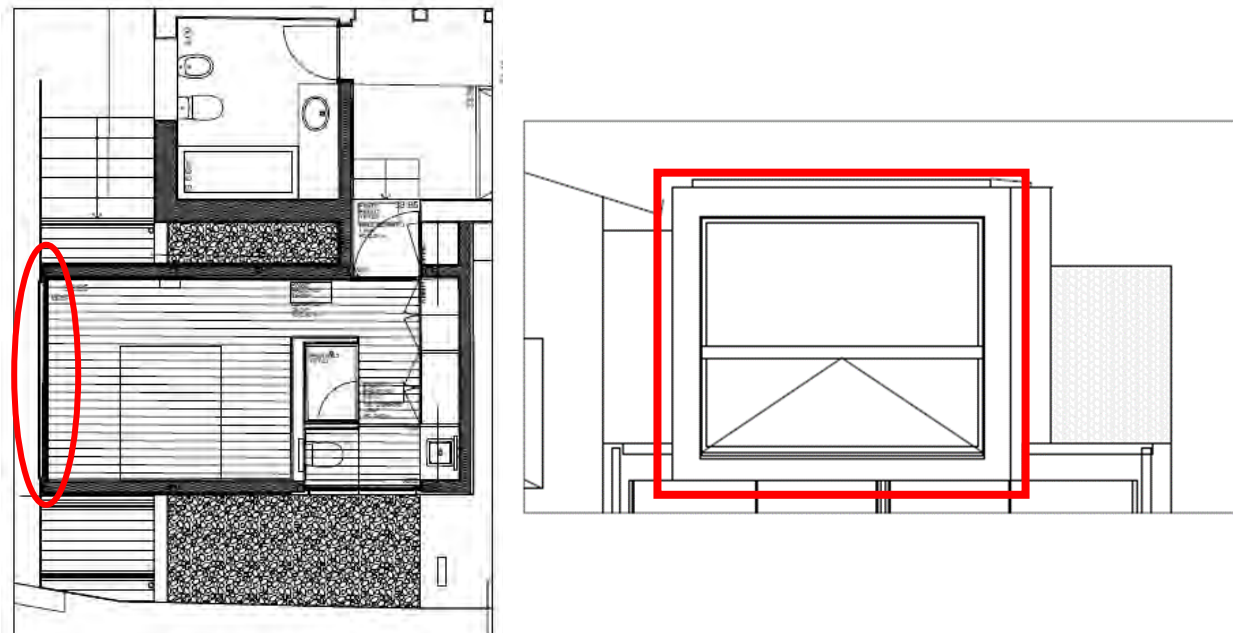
Identificação em planta e alçado da parede exterior do quarto, Pe2.
